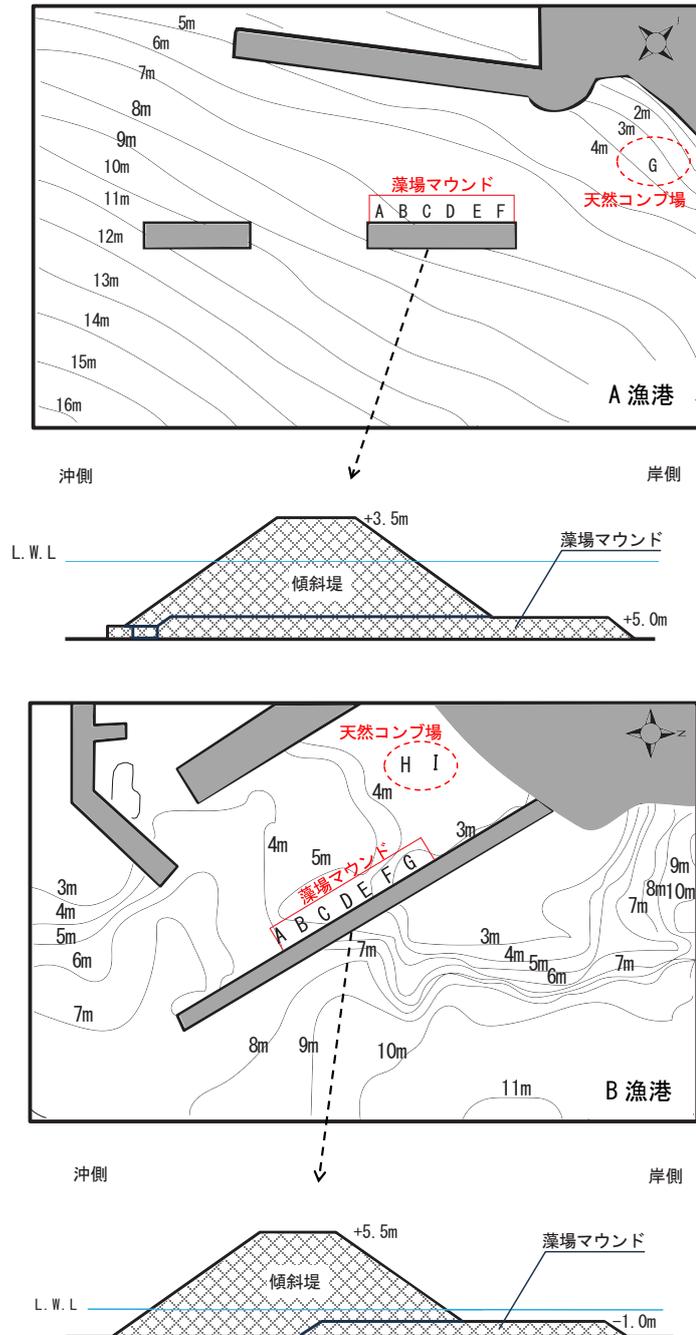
A漁港(上段)、B漁港(下段)の平面図と断面図
